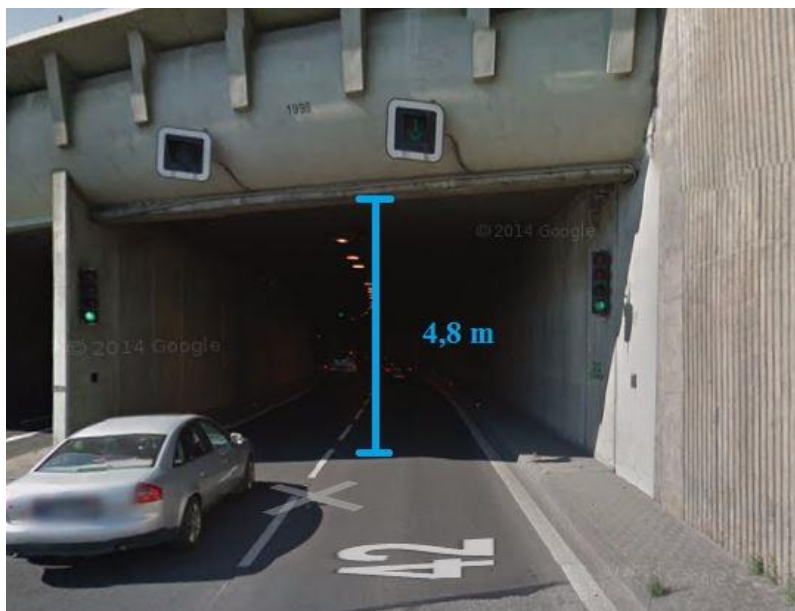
Trasa dopravy autojeřábu na stavbu [7]
